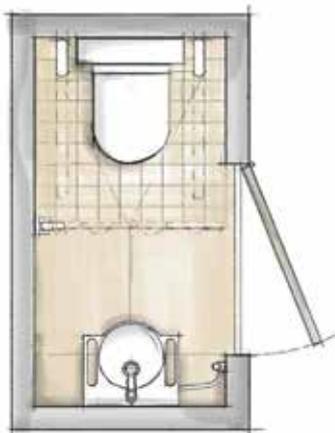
Umbauvariante 1 – Gästetoilette mit Assistenz beim Duschen (Grundriss: DLW)
